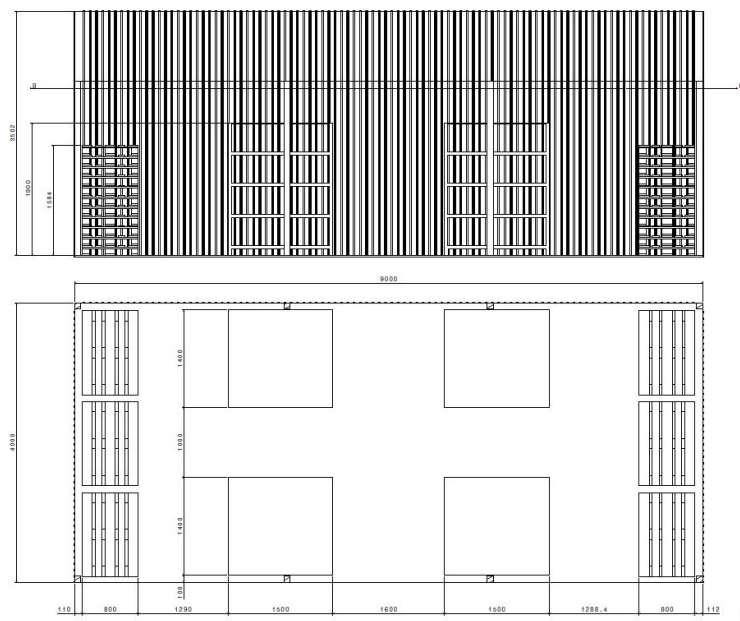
Alzado y planta de la propuesta de la nueva disposición (Anexo IV).
